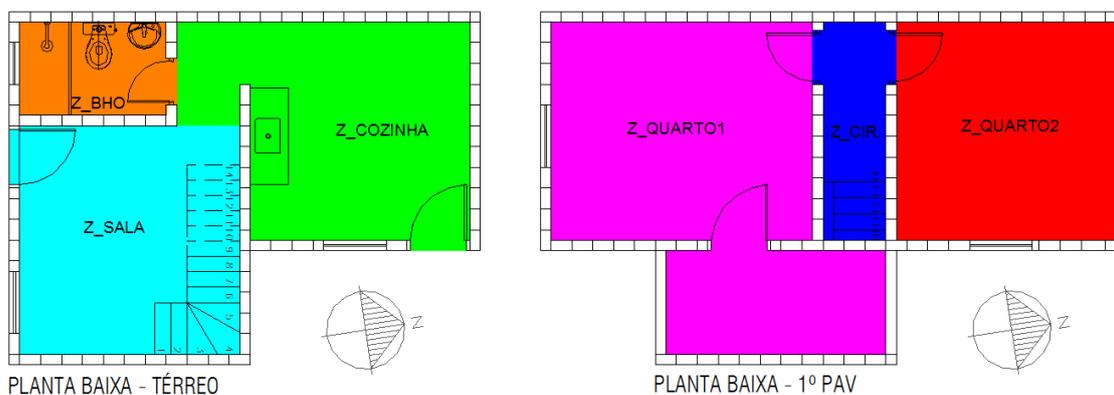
Plantas baixas dos dois pavimentos em zonas térmicas da tipologia sobrado urbano leste
